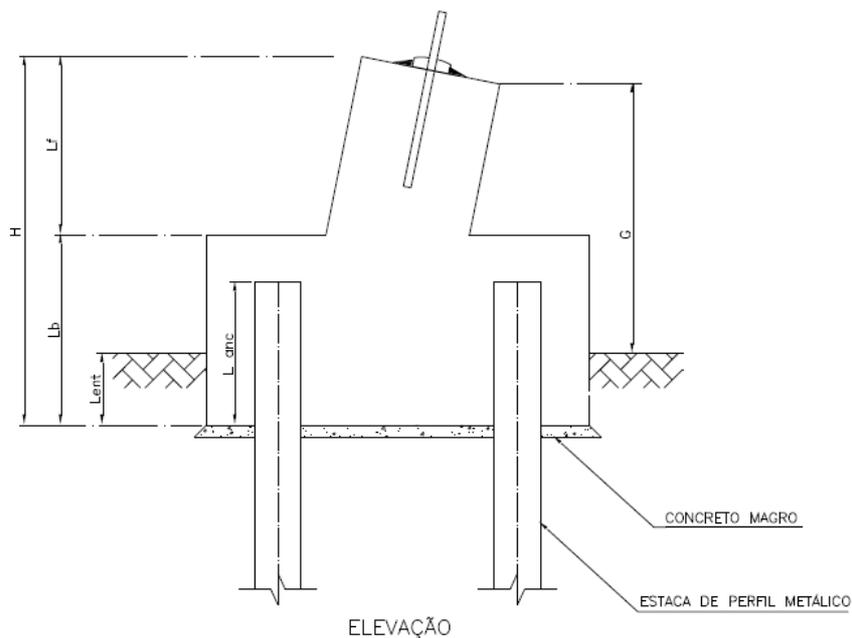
Layout* da fundação tipo estacas para mastros.
